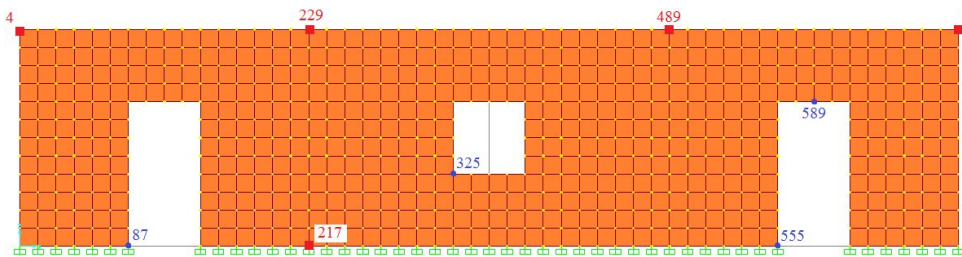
Construção 4.2, rotura por tracção (1)
